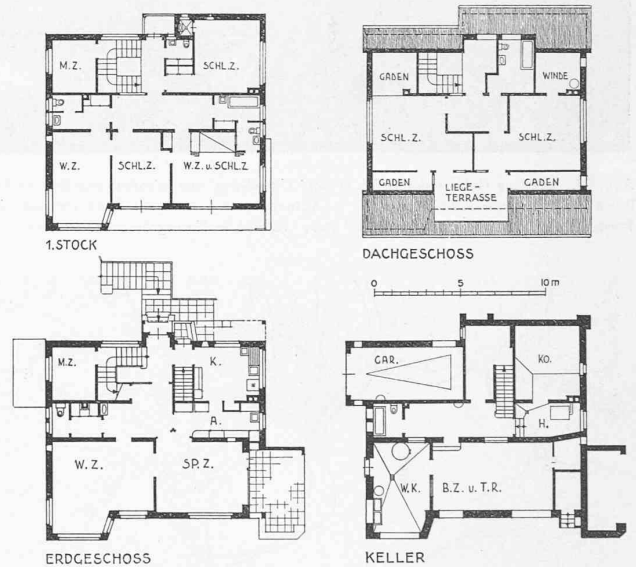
Haus Wegelin. Arch. Max Haefeli sen., Zürich. — Grundrisse 1 : 400.
